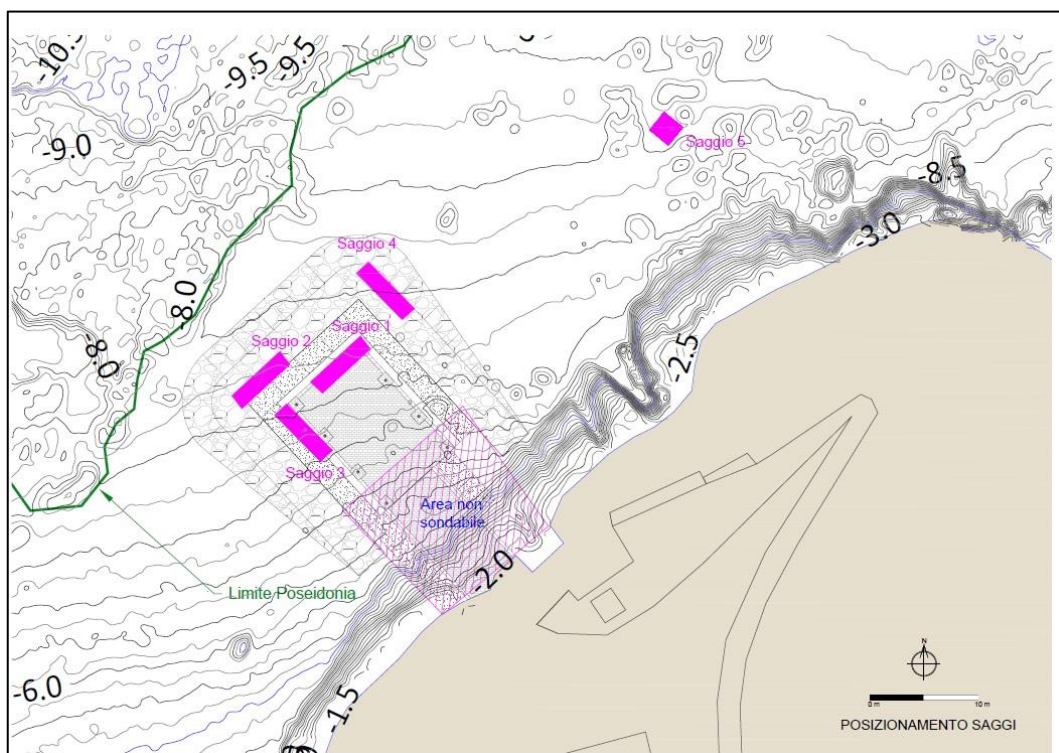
Estratto da Tavola 3: ubicazione dei saggi esplorativi rispetto all'area di progetto
